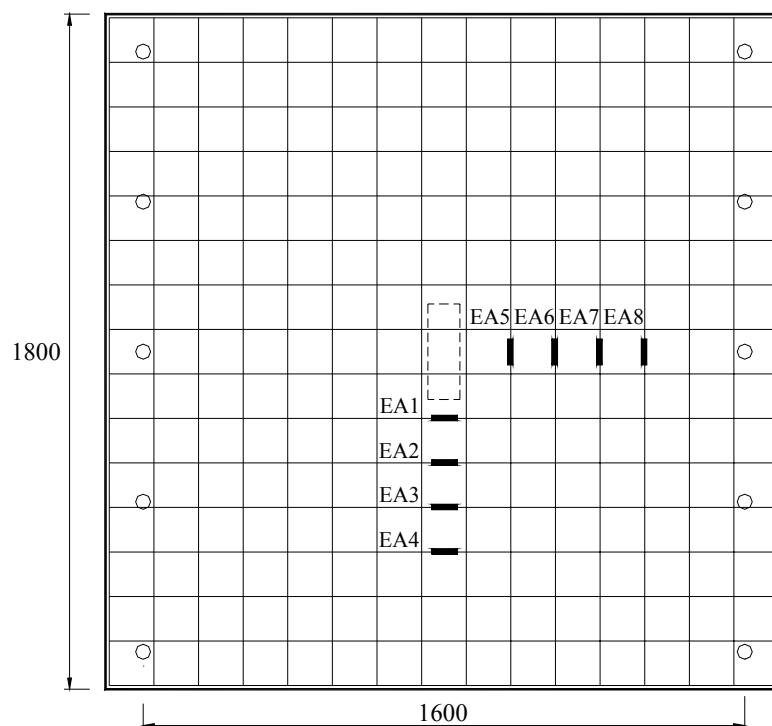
Posição dos extensômetros nas armaduras das lajes de Carvalho (2006)
